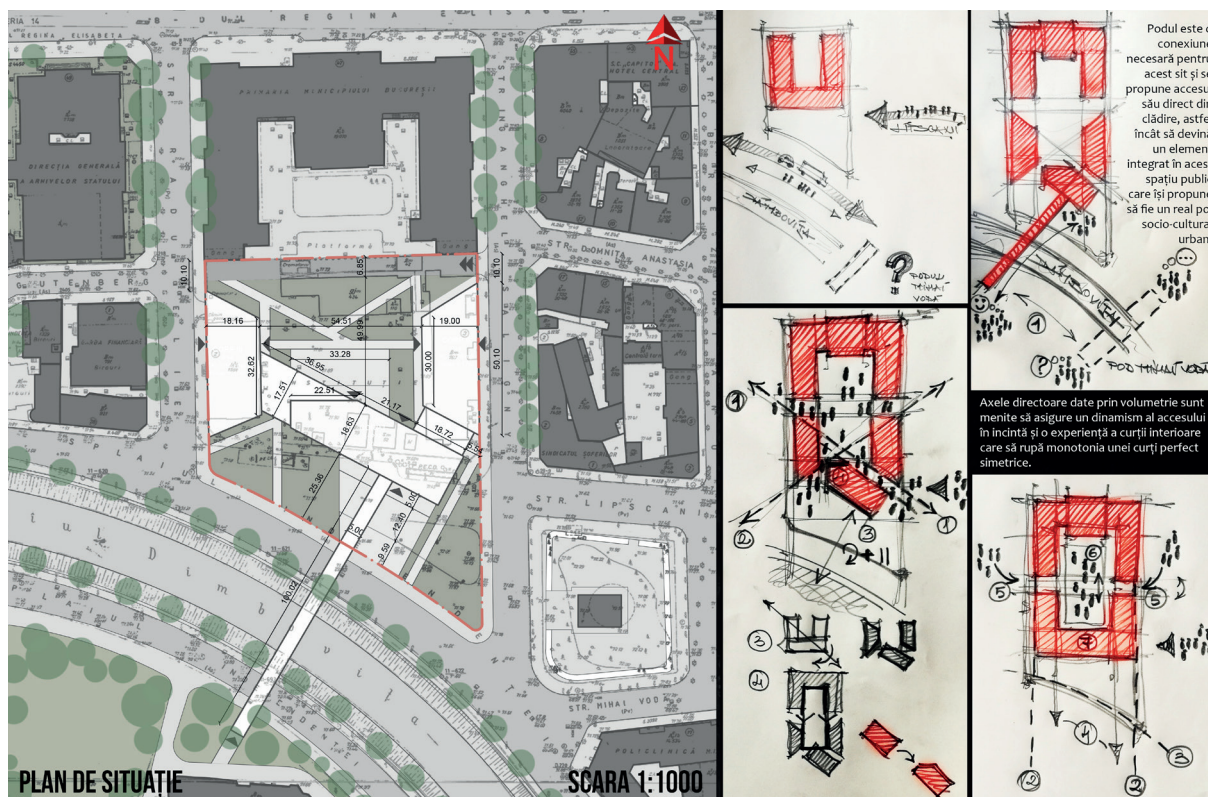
Plan de situație – Propunere – Scheme explicative / Site Plan – Proposal – Explaining sketches
